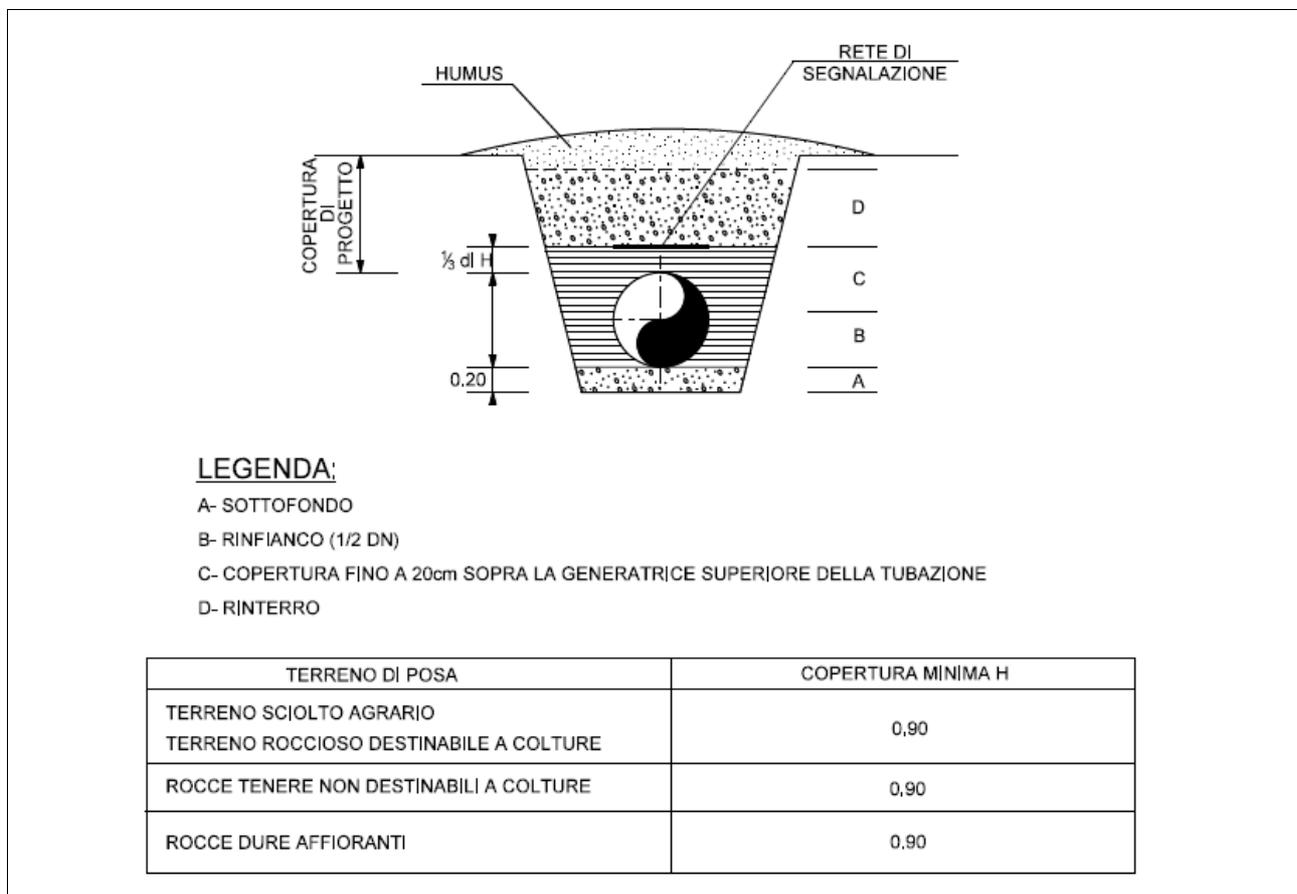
Sezione tipica della trincea di scavo per la posa della condotta - costruzione
